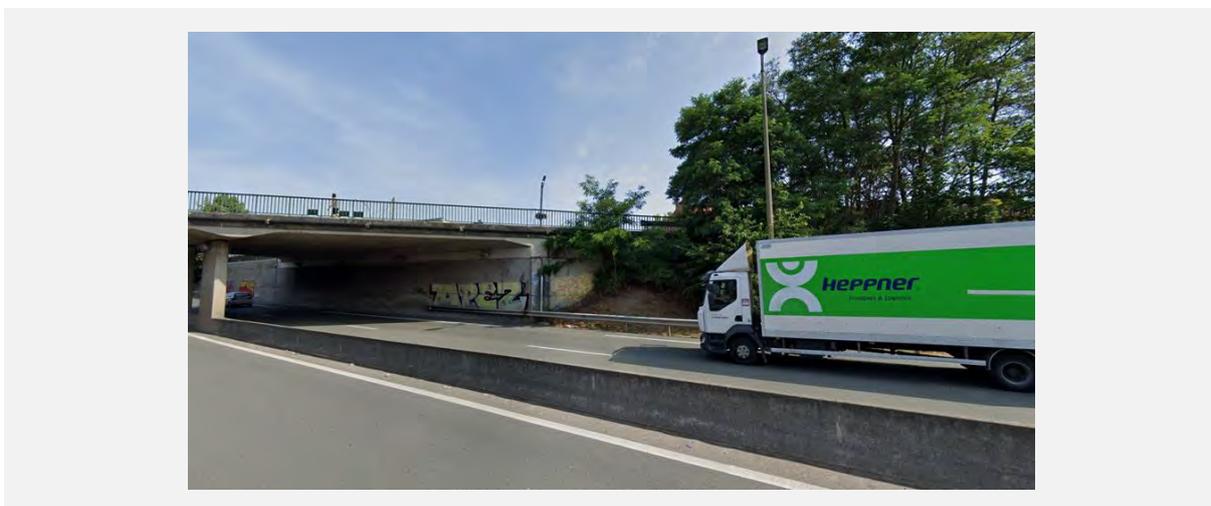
vue au droit du surplombe de l'avenue Jean Jaurès RD 58 E1 avec la RD58 encaissée – Google streetview – juillet 2019
